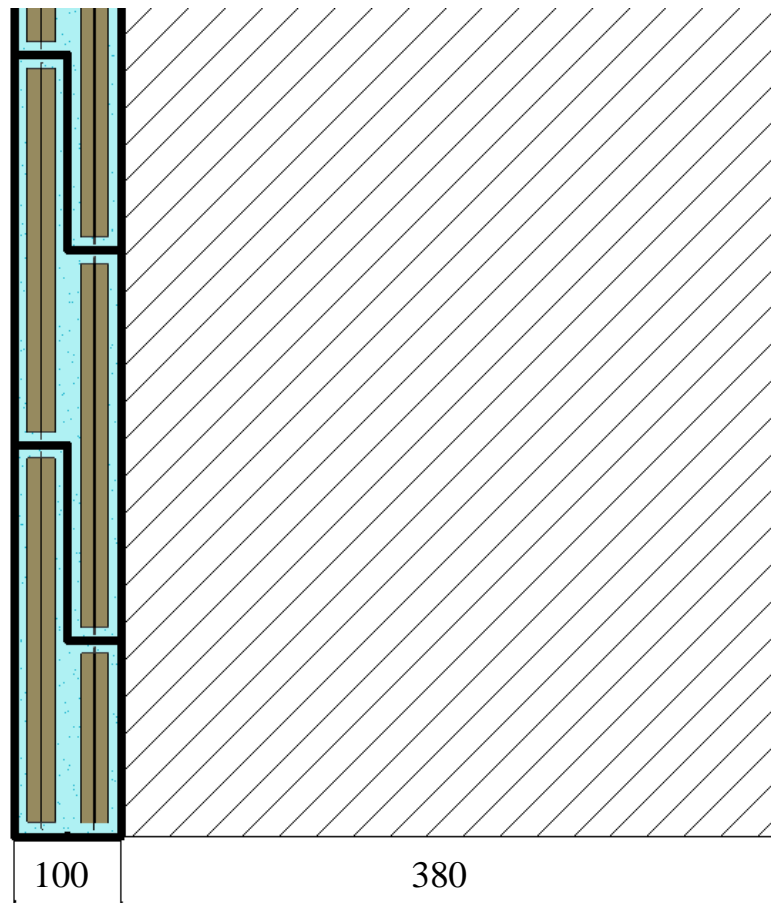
Стіна утеплена плиткою з невентильованими повітряними прошарками
